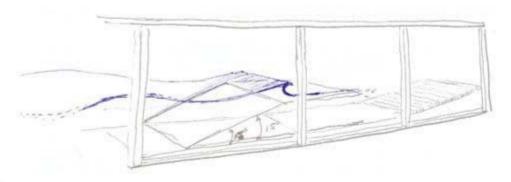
Croquis de lo propuesto. Fuente propia.
